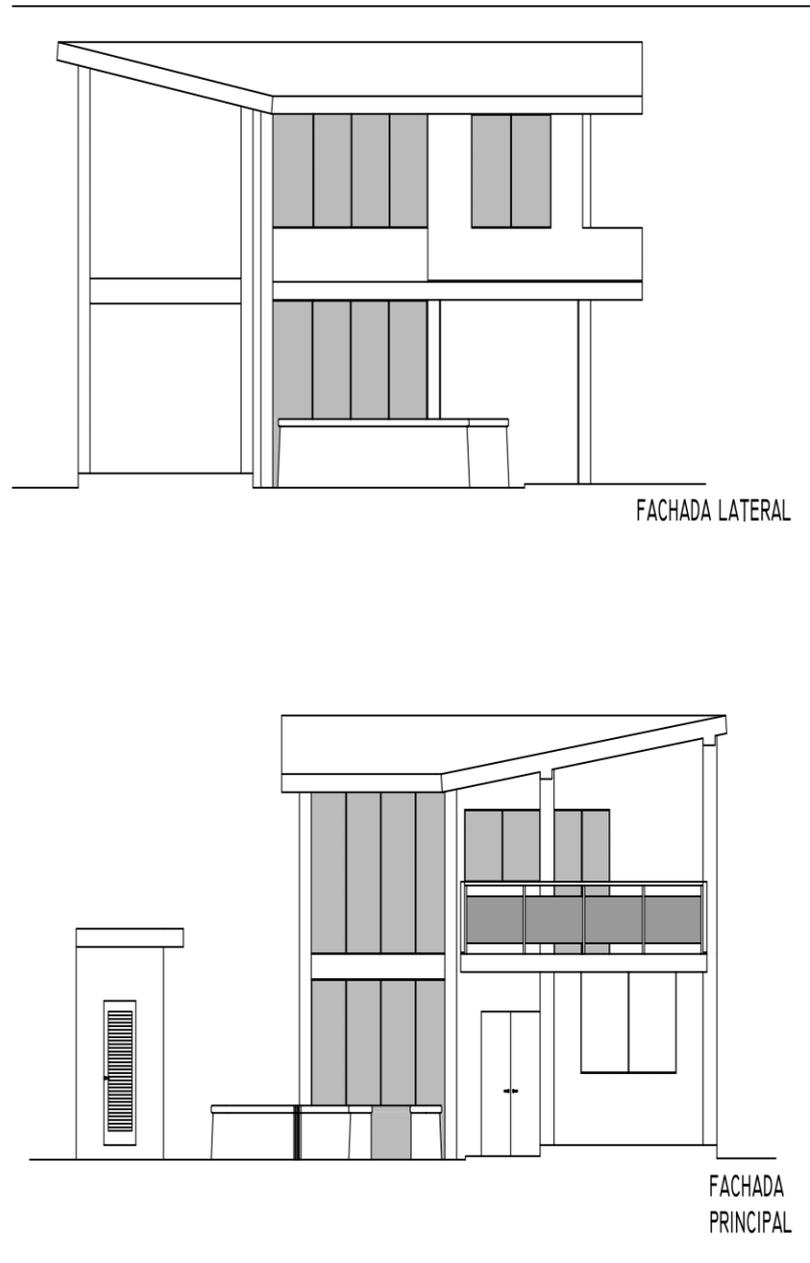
Planos de Proyecto. 2017. Fuente: Tutor de Trabajo de Grado
